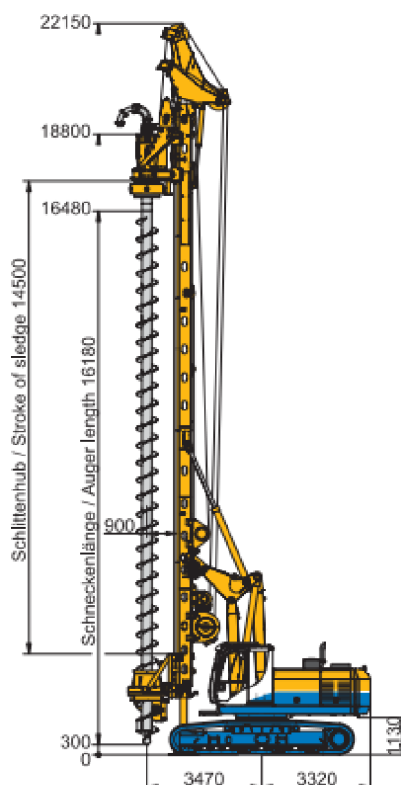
Vrtná souprava Bauer BG20H pro provádění pilot [18]
